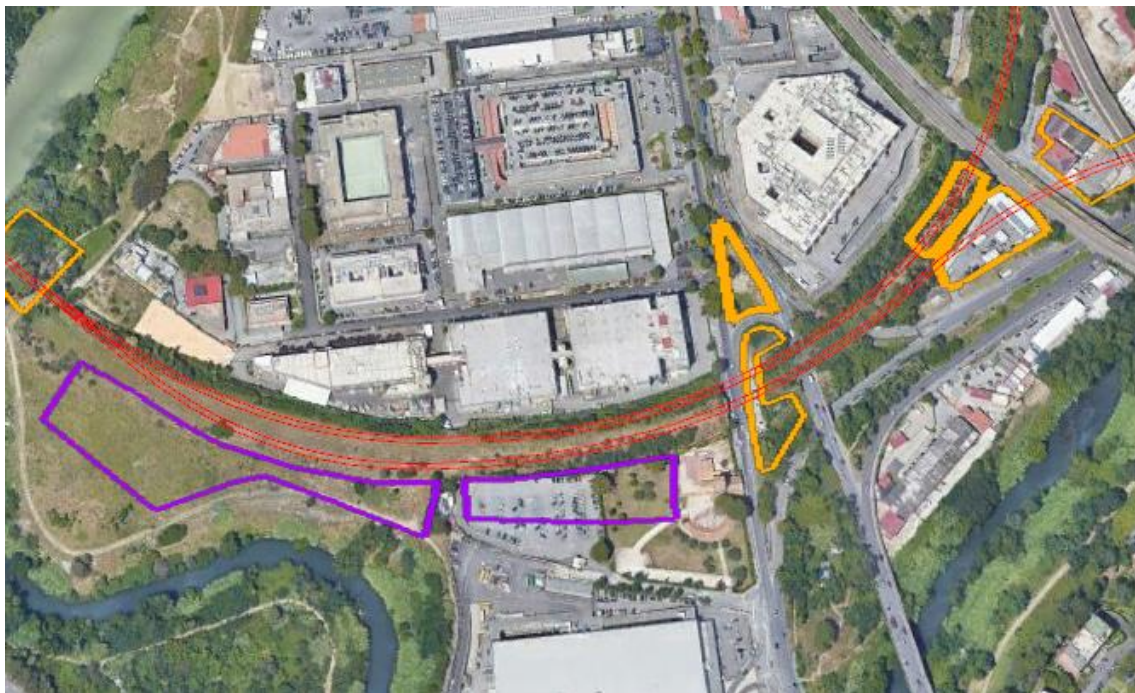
Contesto B: Stralcio planimetrico con le aree di cantiere fisso
